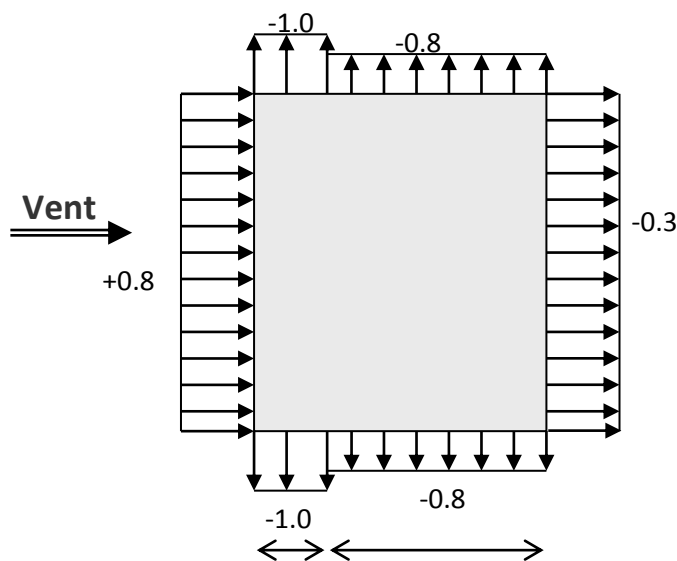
Vue en plan et vue en élévation, sens XZ
